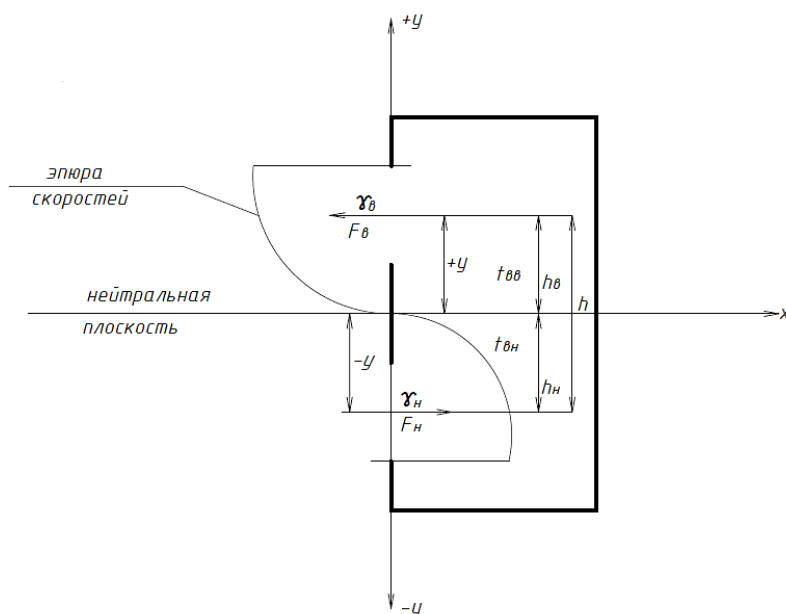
Расчетная схема аэрационных проёмов однопролетного одноэтажного здания (вертикальный разрез)
